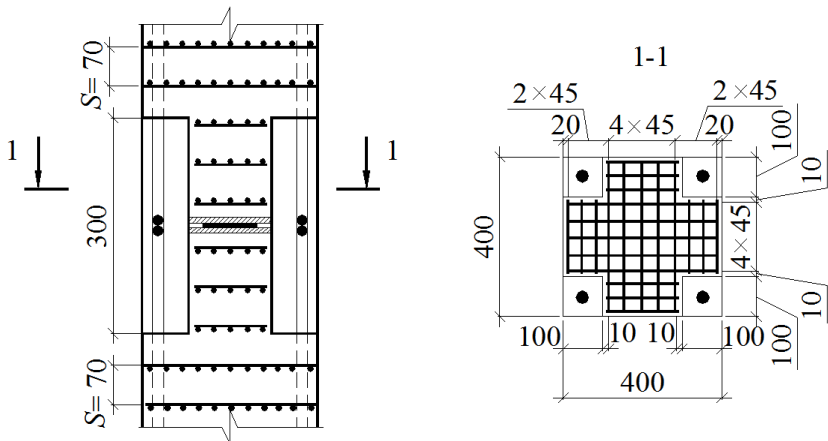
Стык колонн с ванной сваркой выпусков арматуры
